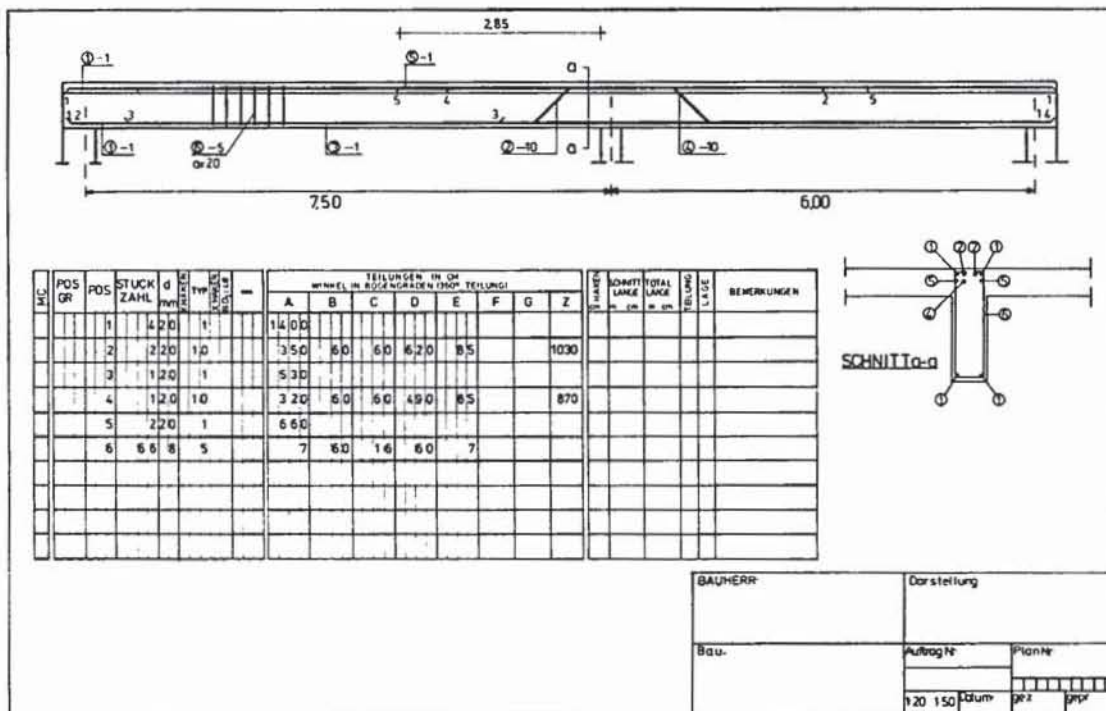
Vereinfachter Bewehrungsplan für einen Zweifeldträger nach Bild 3 Zeichnung mit unmaßstäblichem Bewehrungsauszug in der Stahlliste
